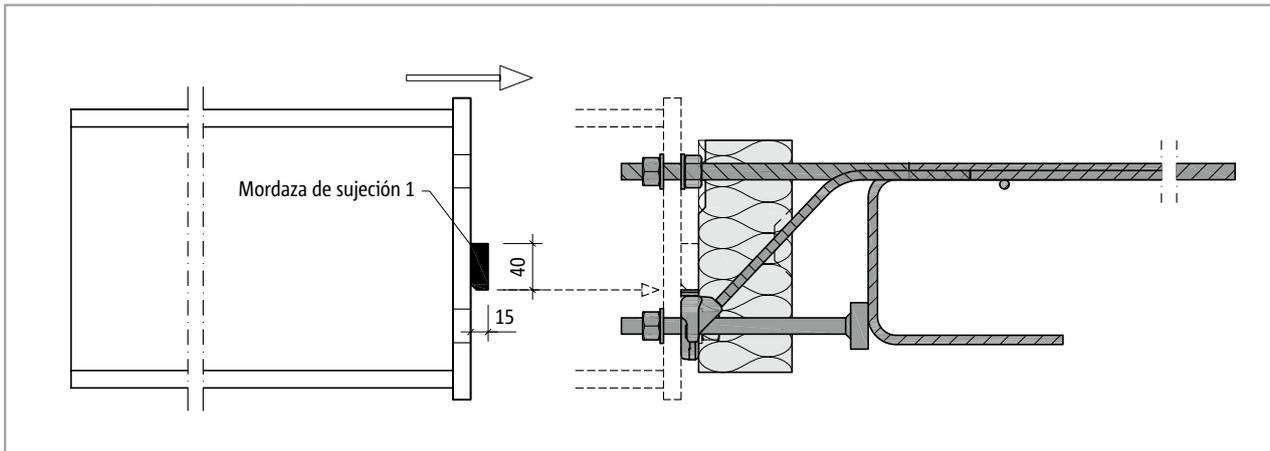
Schöck Isokorb® T tipo SK: Montaje de la viga de acero
